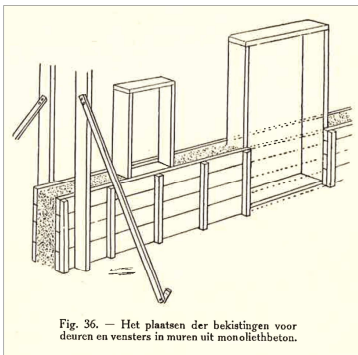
Het plaatsen der bekistingen voor deuren en vensters in muren uit monolithisch beton.
